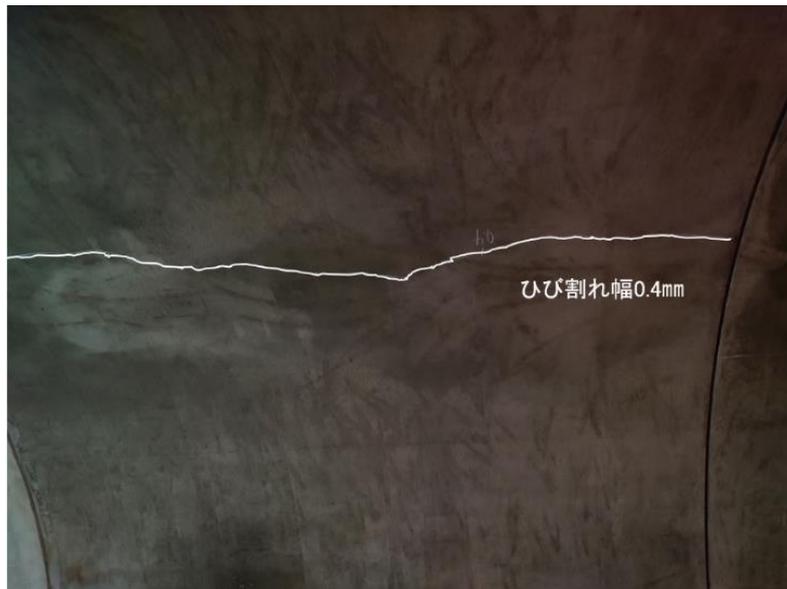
天端部に生じた縦断方向ひび割れ
